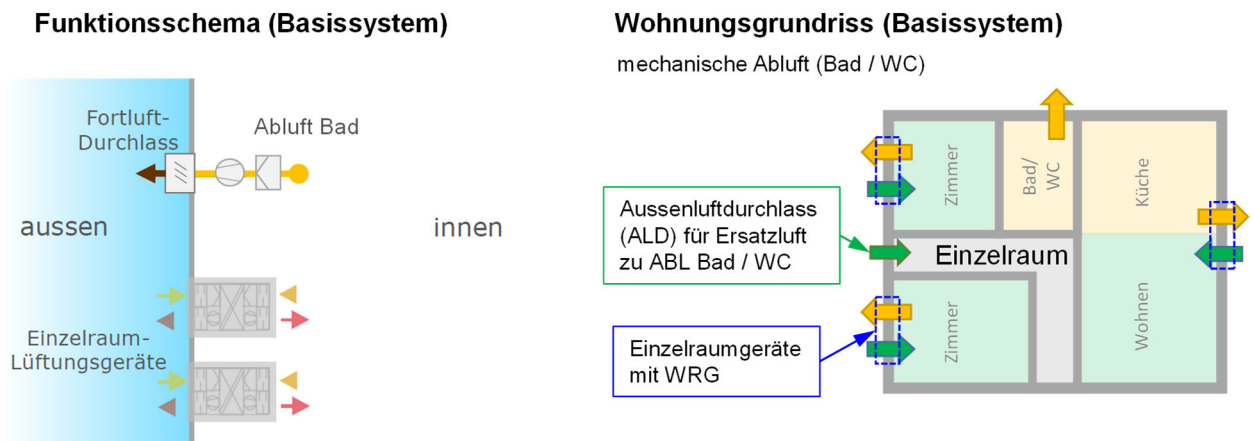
Funktionsschema und Wohnungsgrundriss vom LK3
